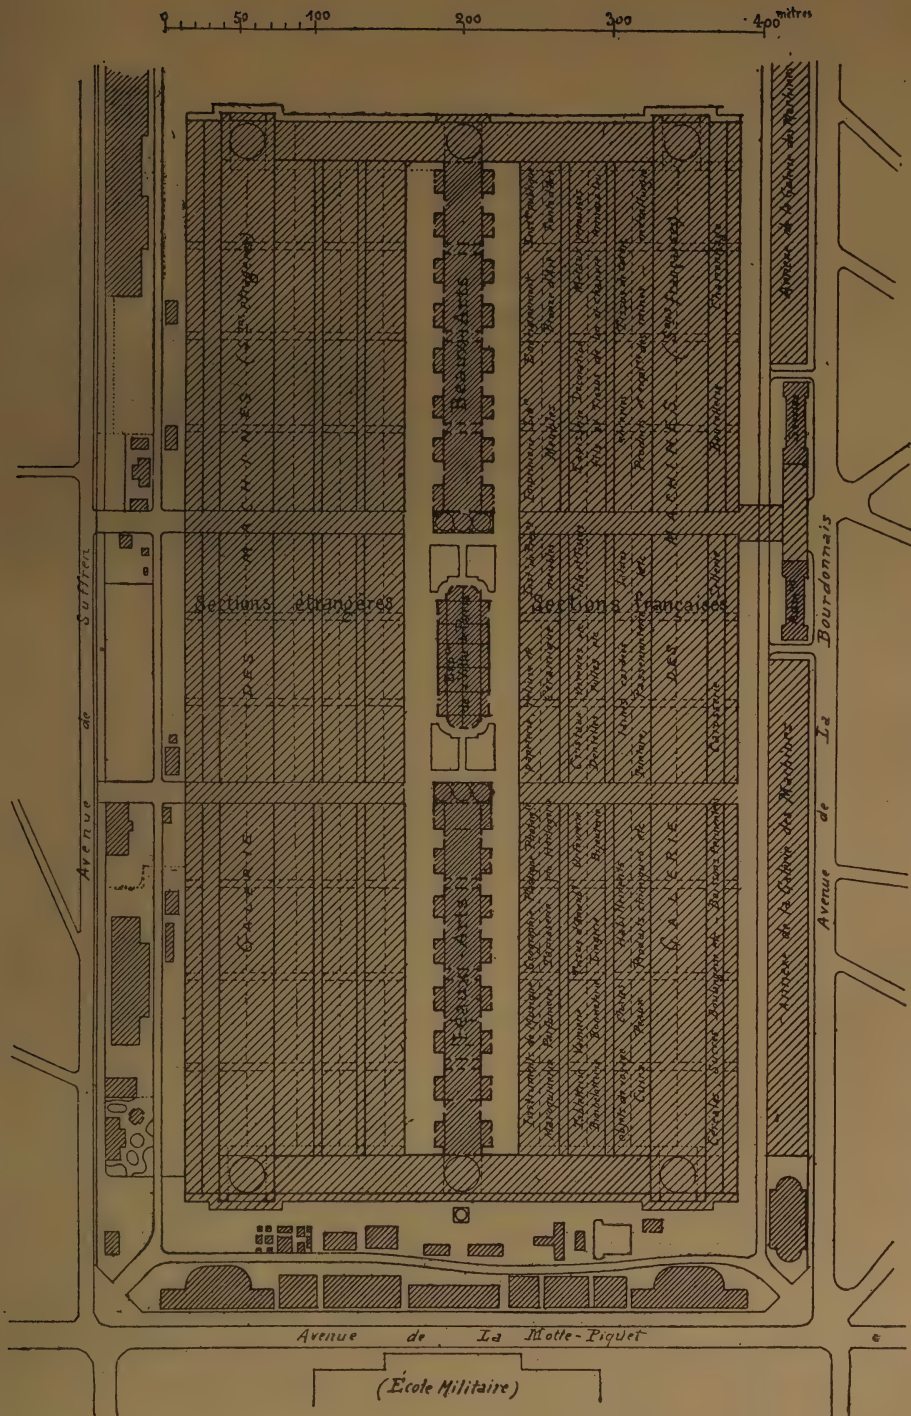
Plan de l'exposition de 1878, à Paris.
